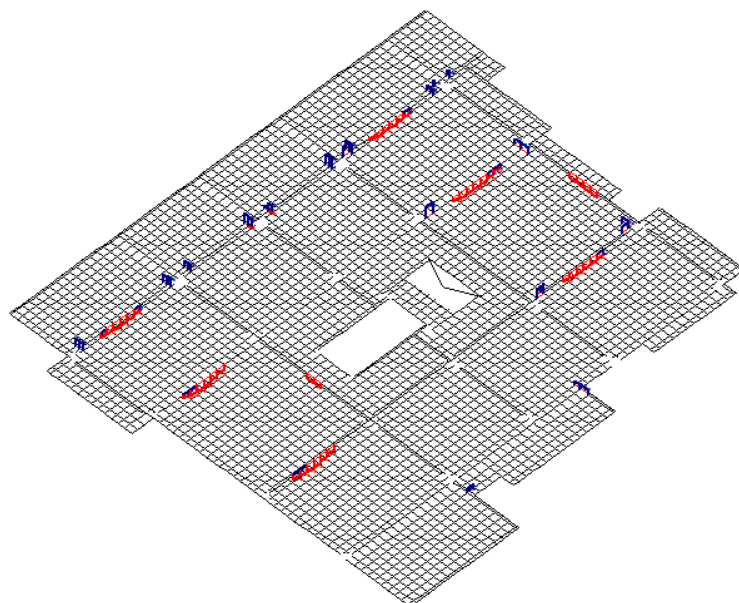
Aspecto geral da abertura de fissuras no pavimento PT1 da Solução Convencional
